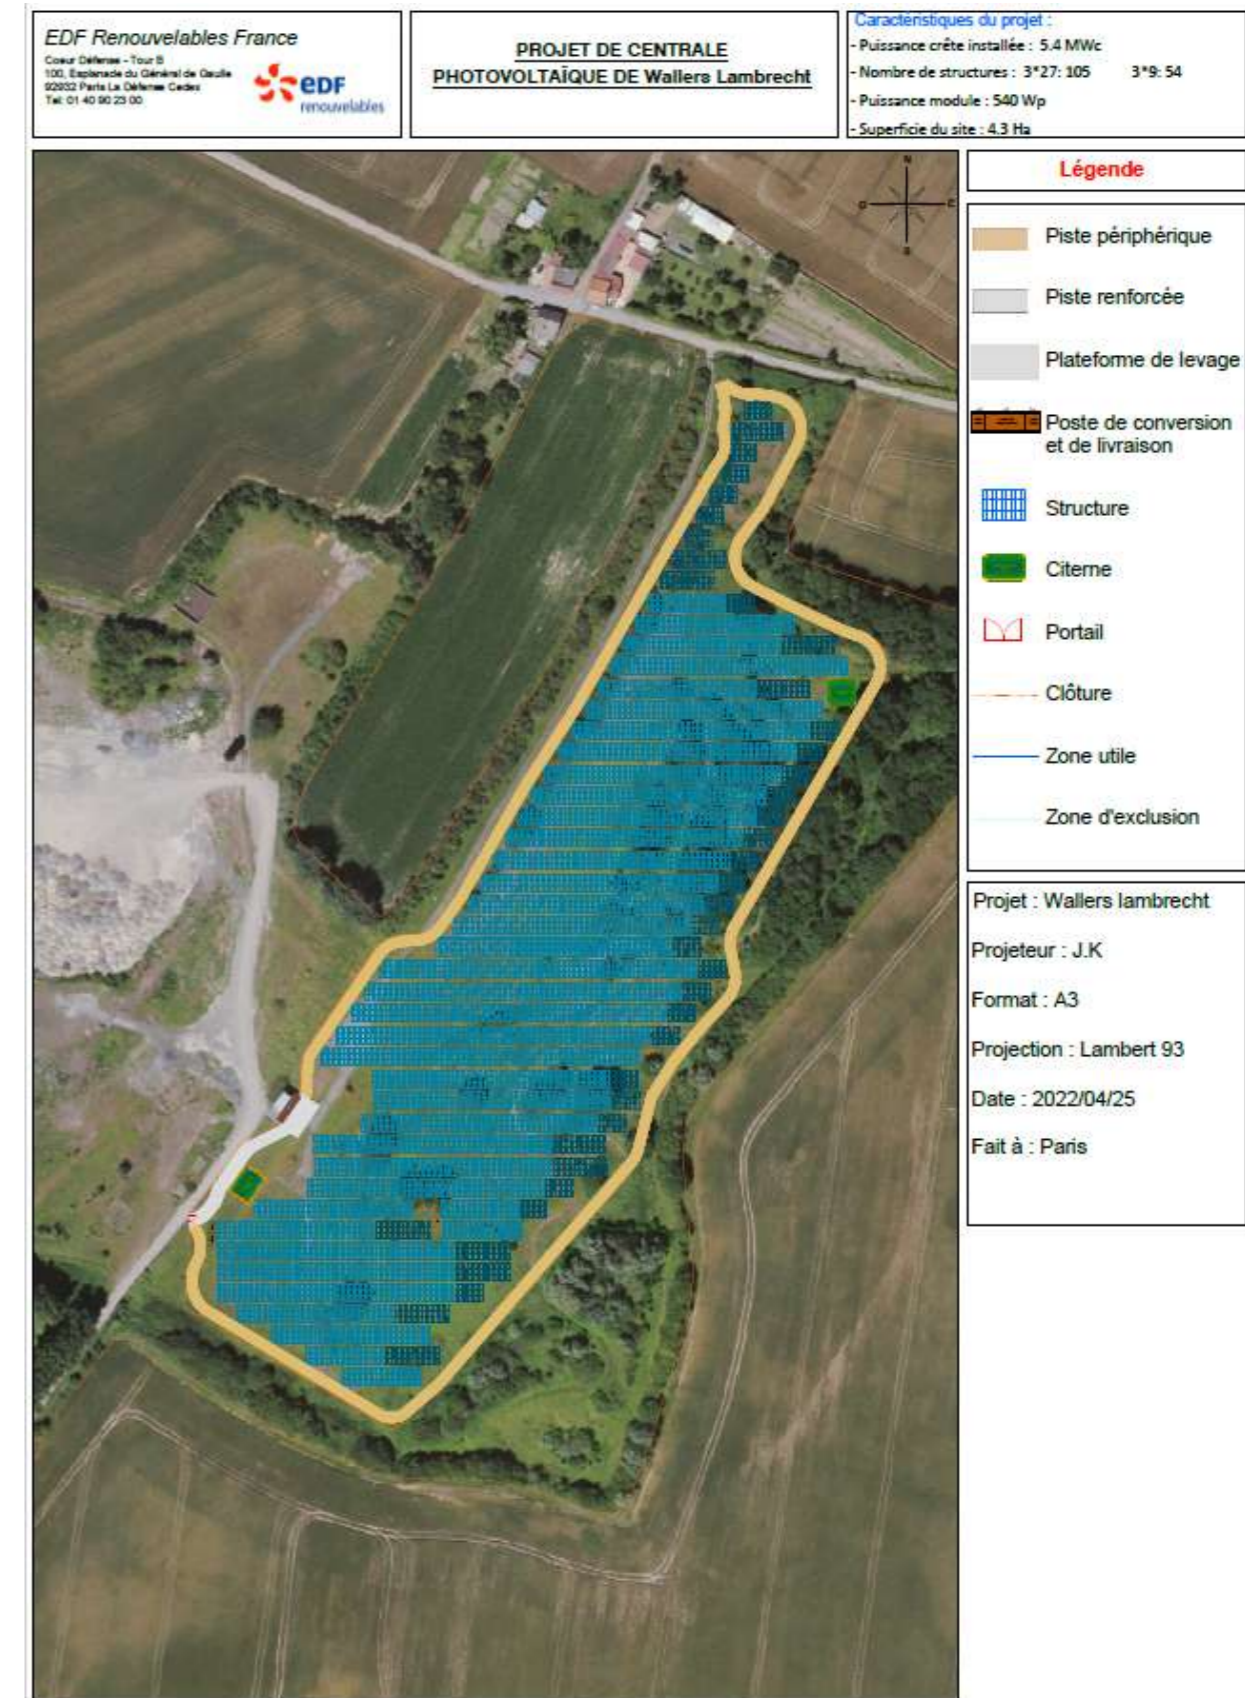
Design de la centrale photovoltaïque de Wallers Lambrecht
